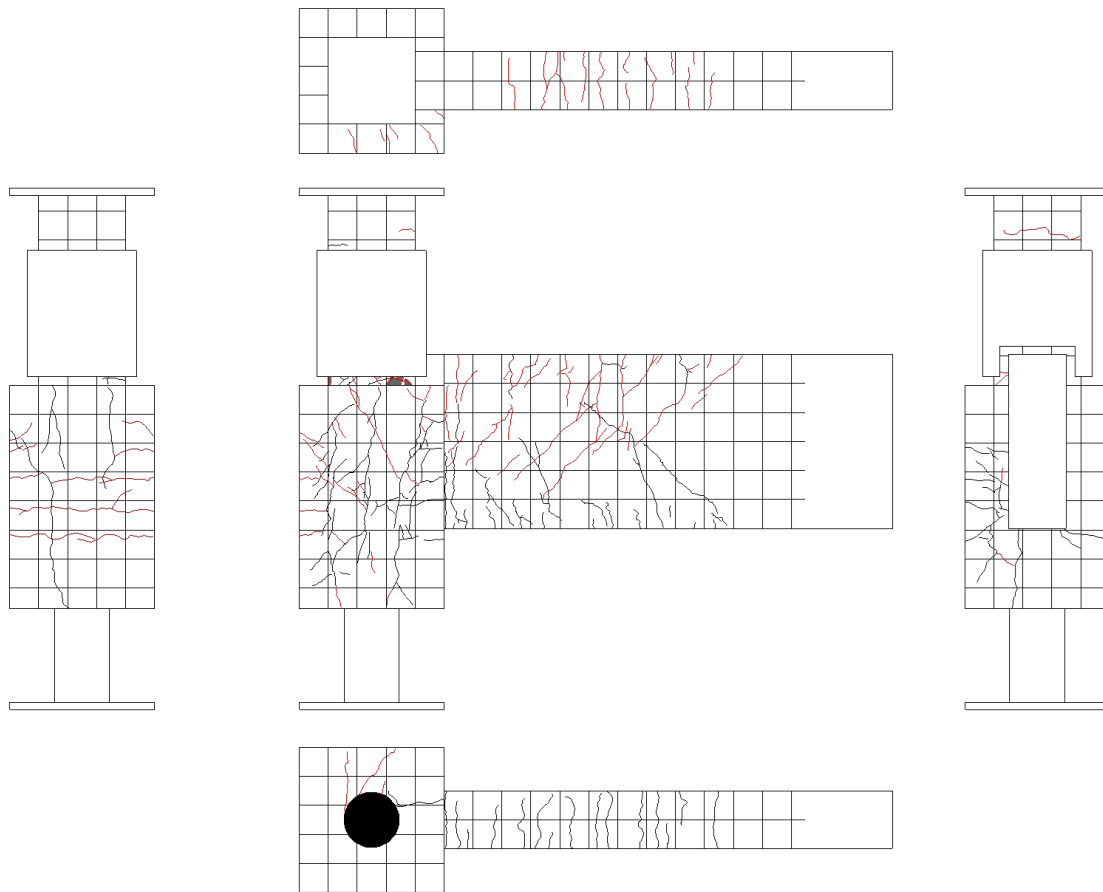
試験体 A-1 ひび割れ状況 (5Cycle)
